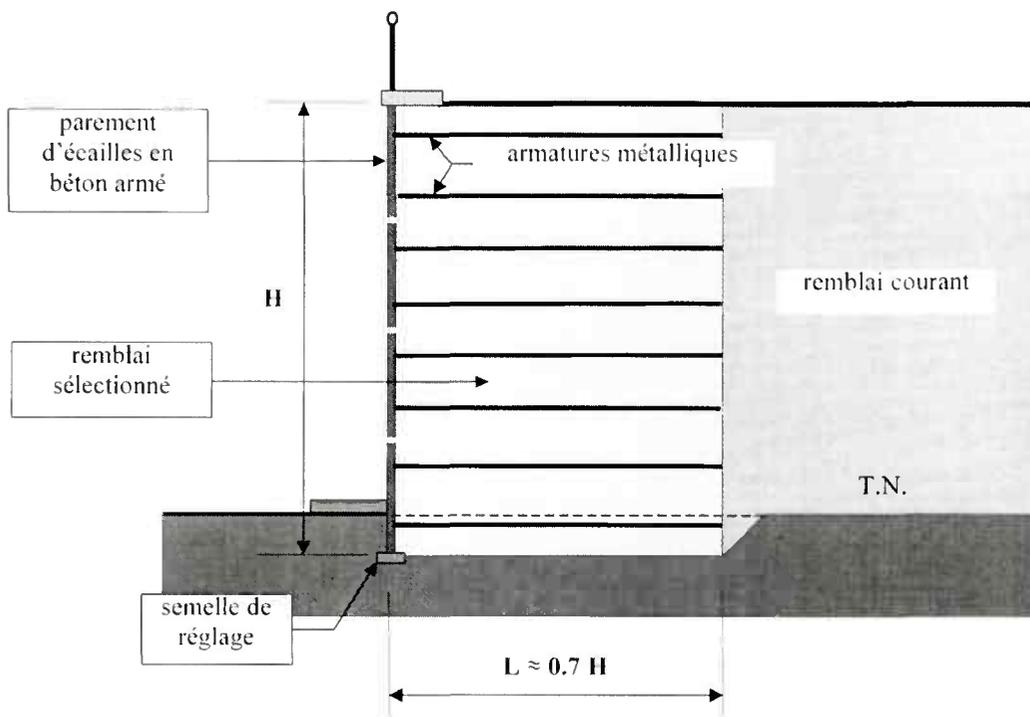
Dimensionnement courant d'un massif en remblai renforcé
